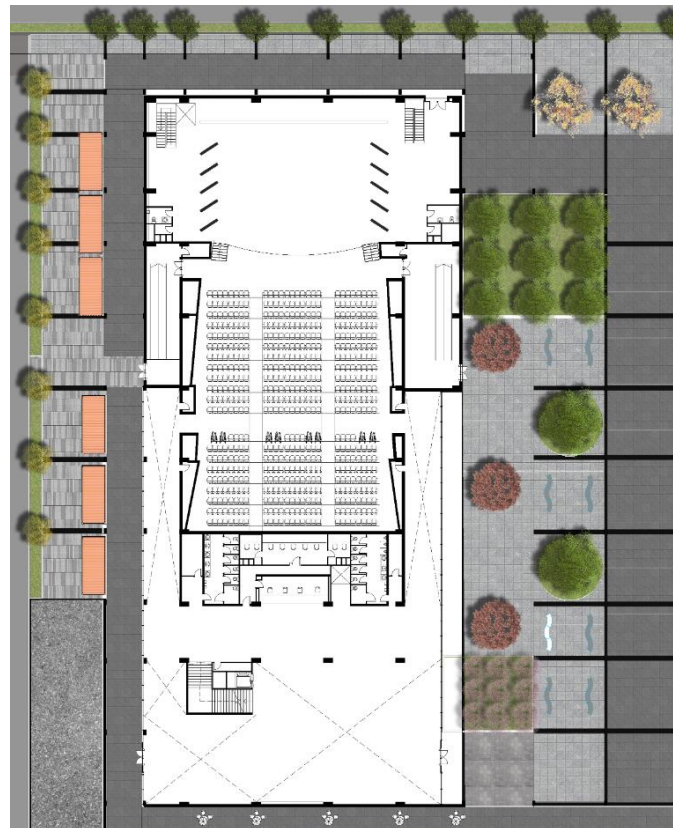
Planta baja Bloque Auditorio. Fuente: Elaboración Propia
